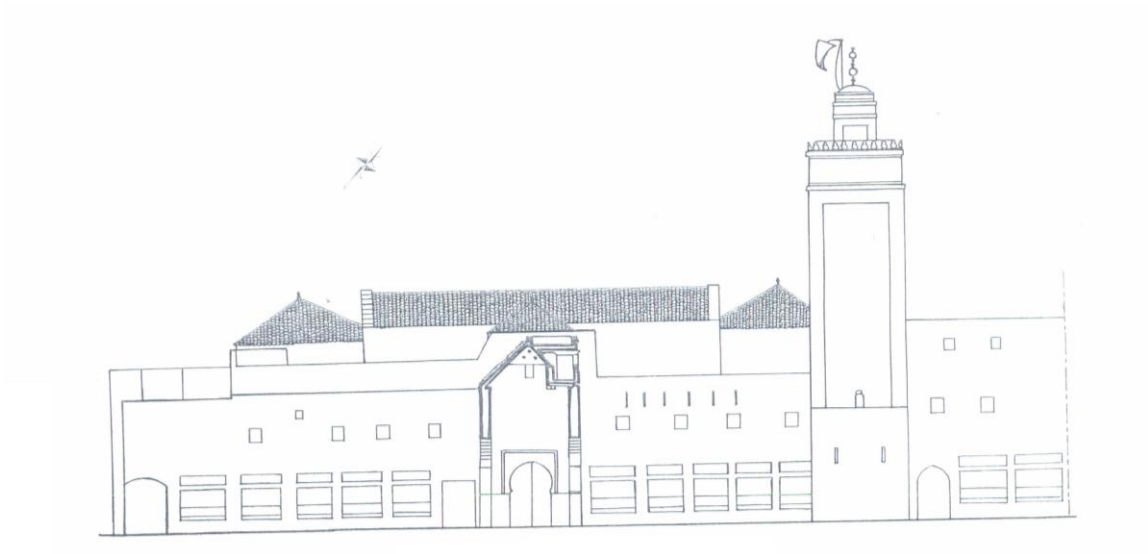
Plan de la façade de la médessa Al bou Inaniyya
